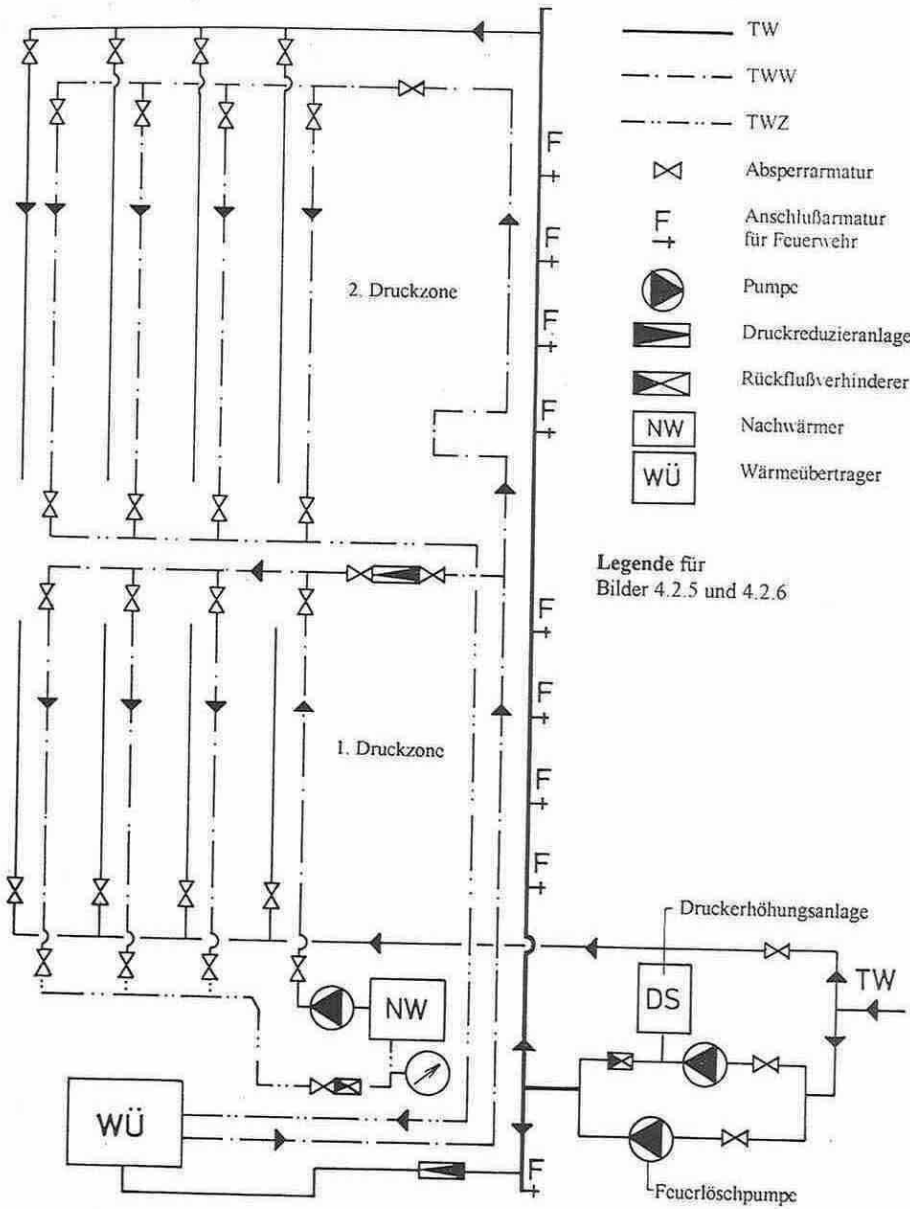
Schematische Darstellung der Trinkwasser-Versorgungsanlage mit zwei Druckzonen eines Wohnhochhauses, Variante I - Berliner Ausführung
